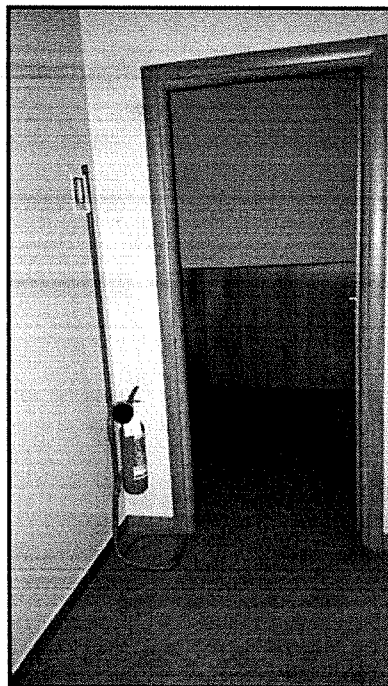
Vista interni – Corridoio visto verso ufficio 1
